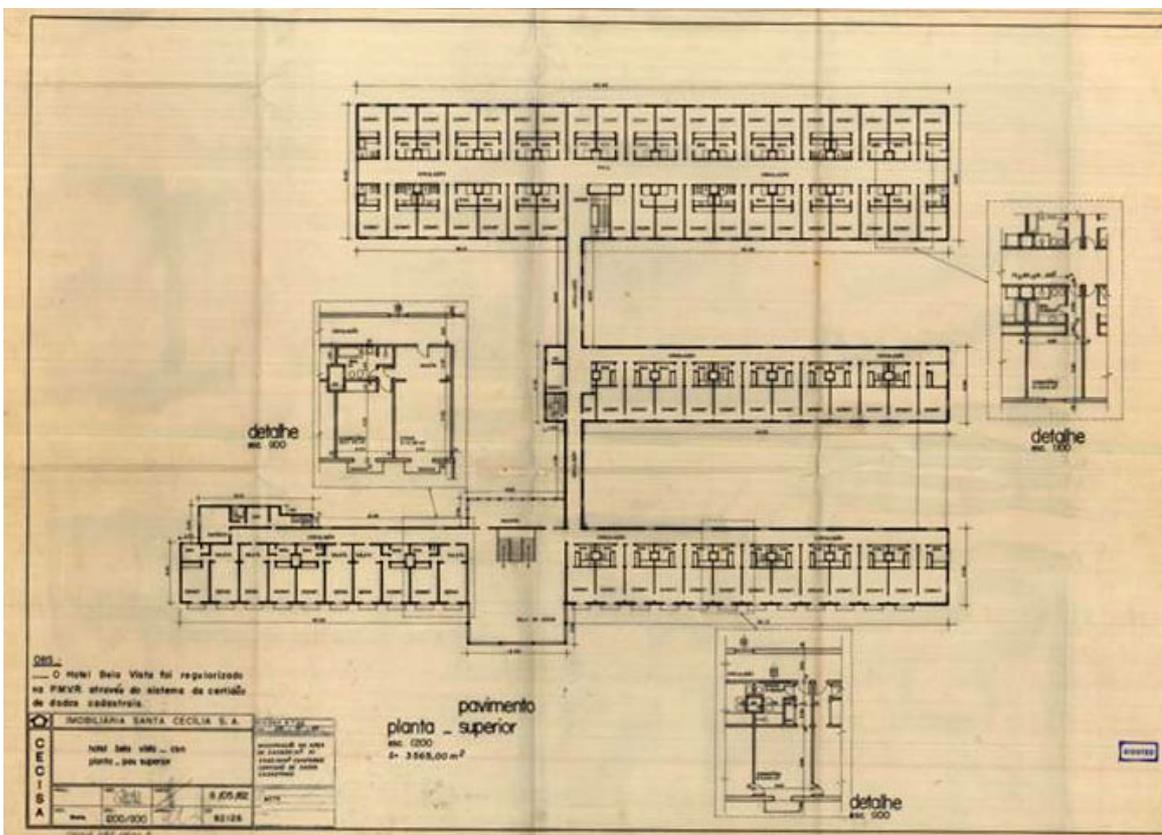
Projeto Construtivo – Pavimento Superior (1982).
